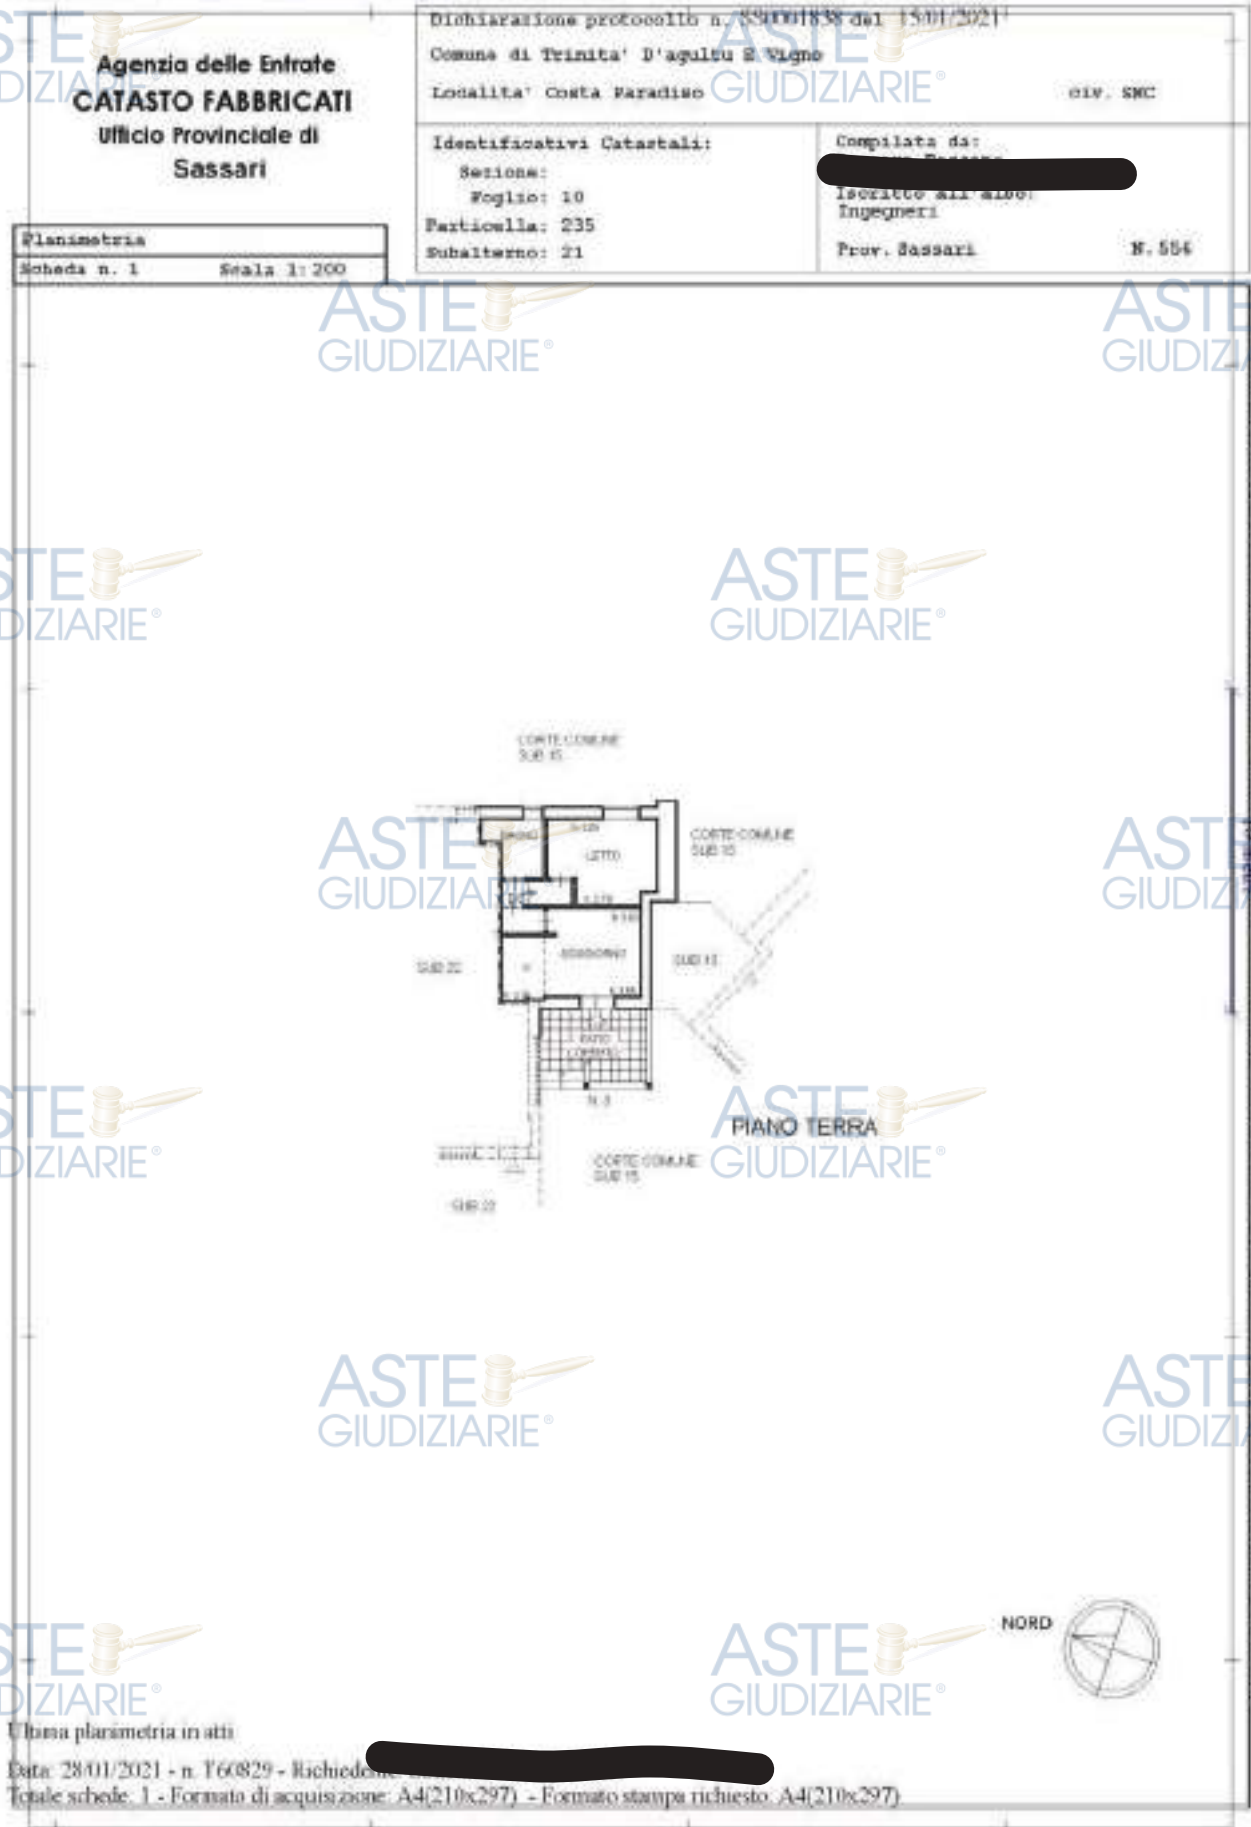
Visura planimetrica catastale Fig. 10 Part. 235 Sub 21 (ex parte Fig. 10 Part. 235 Sub 10)
